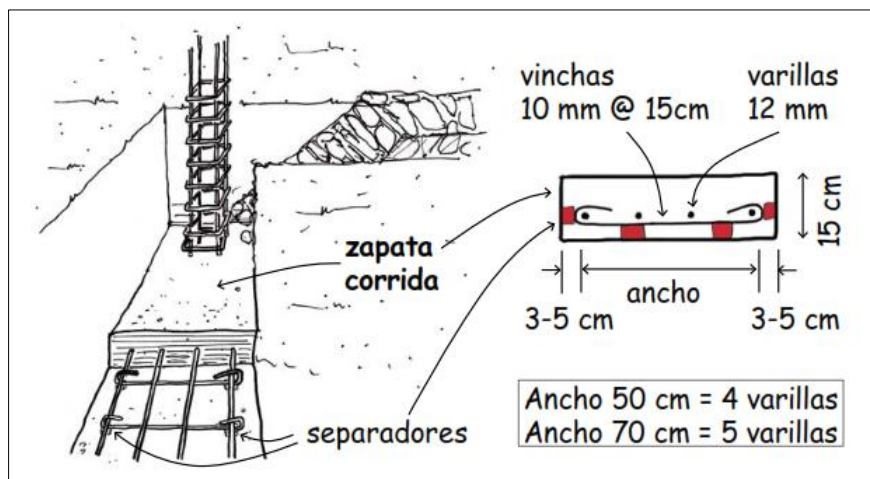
Dimensión propuesta para cimentación, zapata corrida
